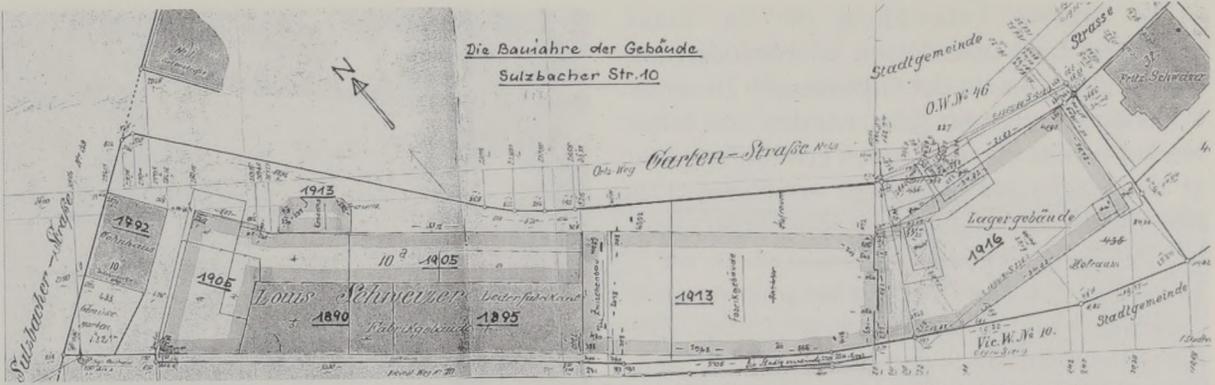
Lageplan Sulzbacher Straße 10 mit den in Abschnitten entstandenen Fabrikbauten von 1890 bis 1916.
